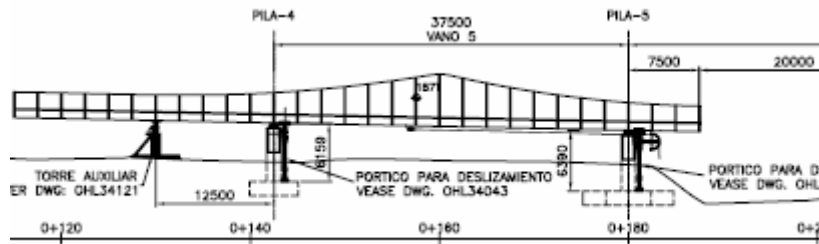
Tramo de la estructura Eje 1 lanzado desde Pila 5
